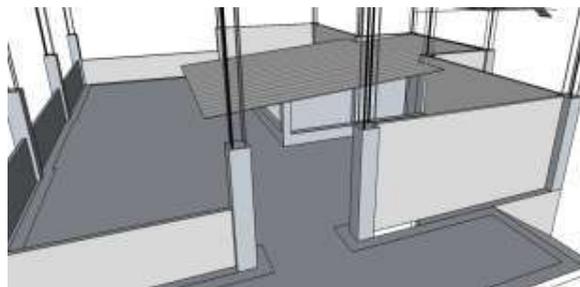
Desain rencana konstruksi bangunan dengan dinding beton tipis
